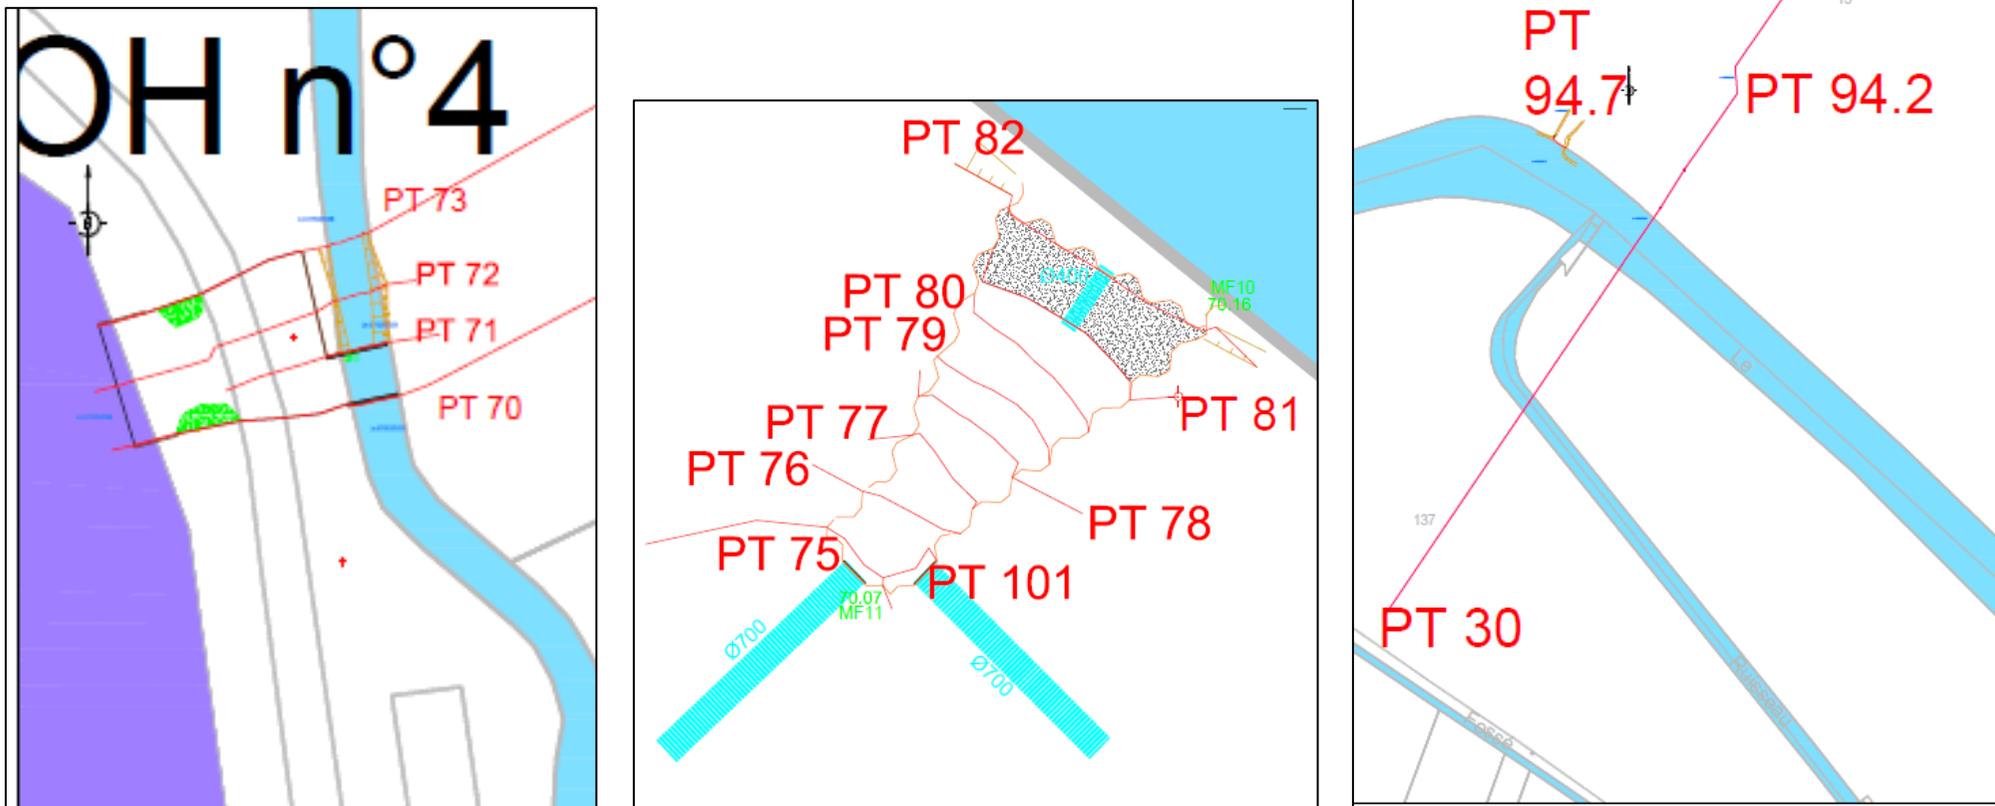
Localisation des profils en travers au droit de l'alimentation du plan d'eau, du déversoir en palplanches et de la brèche rive gauche amont
